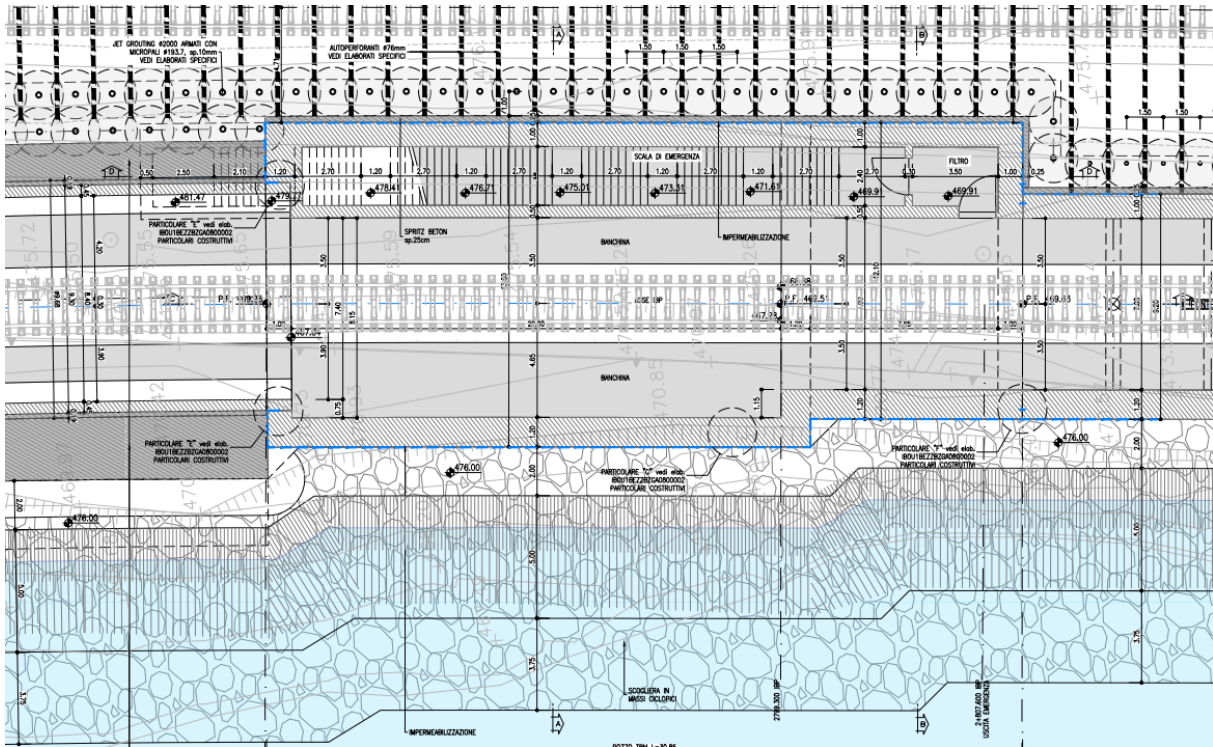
Pianta scala Interconnessione Ponte Gardena
